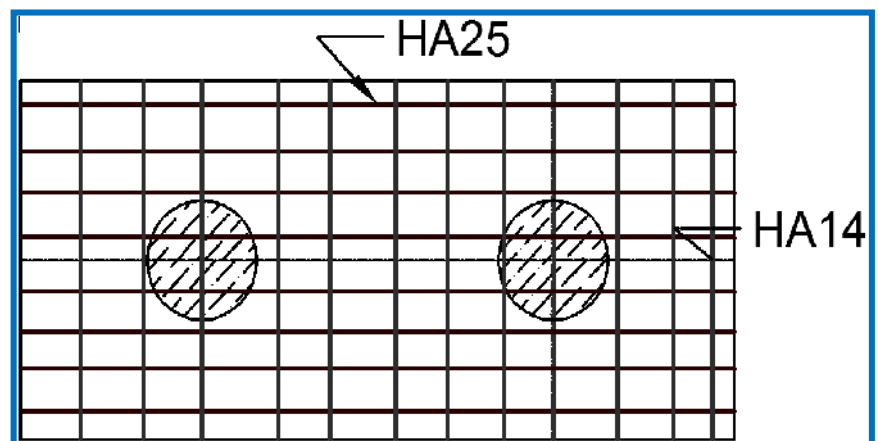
ferrailage de la nappe supérieure de la semelle
